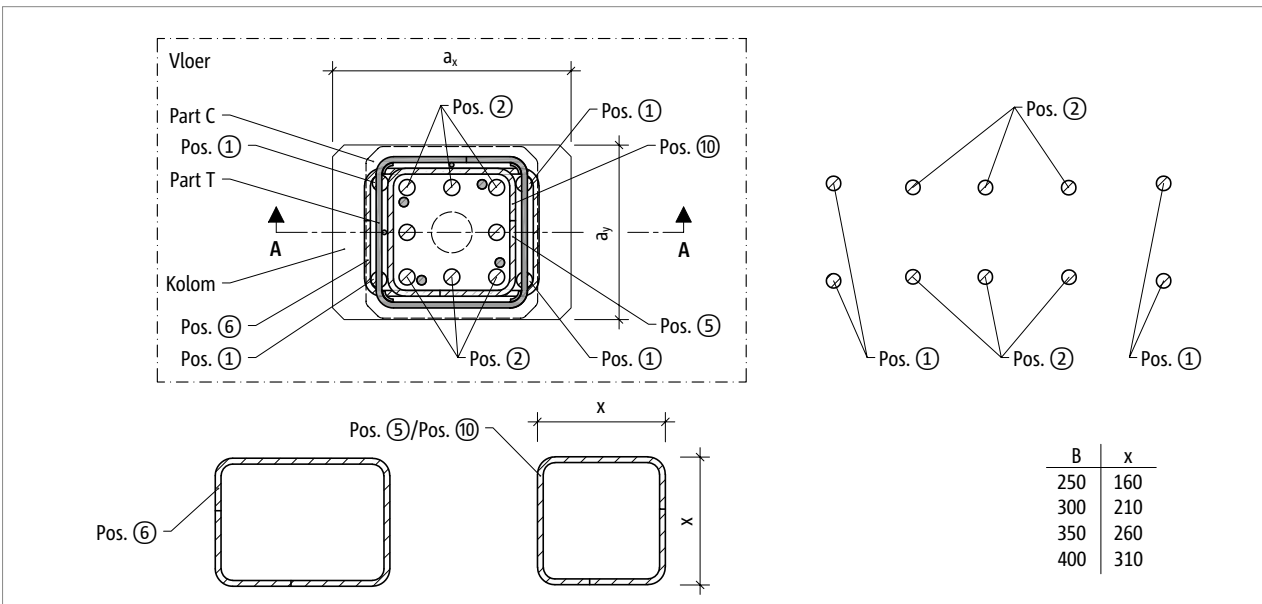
Schöck Sconnex® type P: bijlegwapening in de kolomdoorsnede
